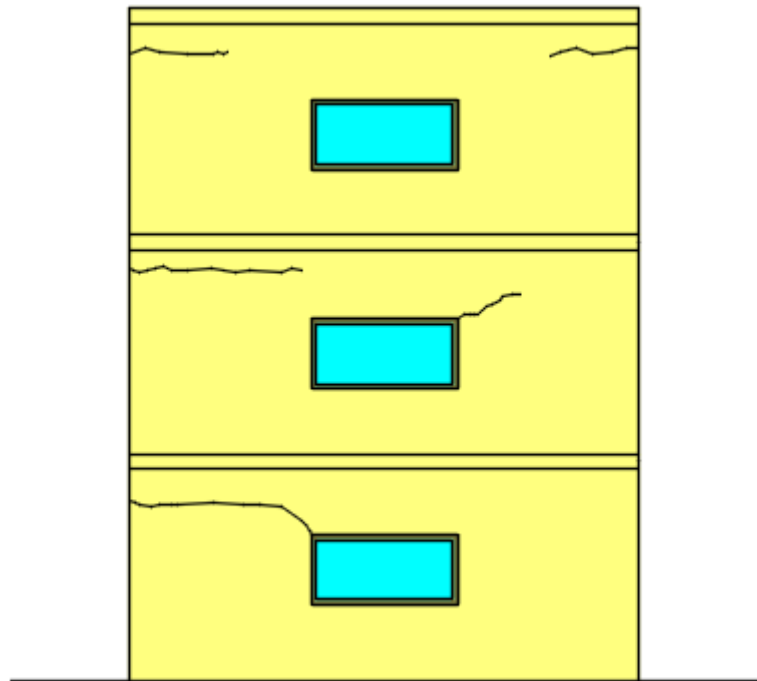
Fissuras em parede externa, promovidas pela retração da laje de cobertura
